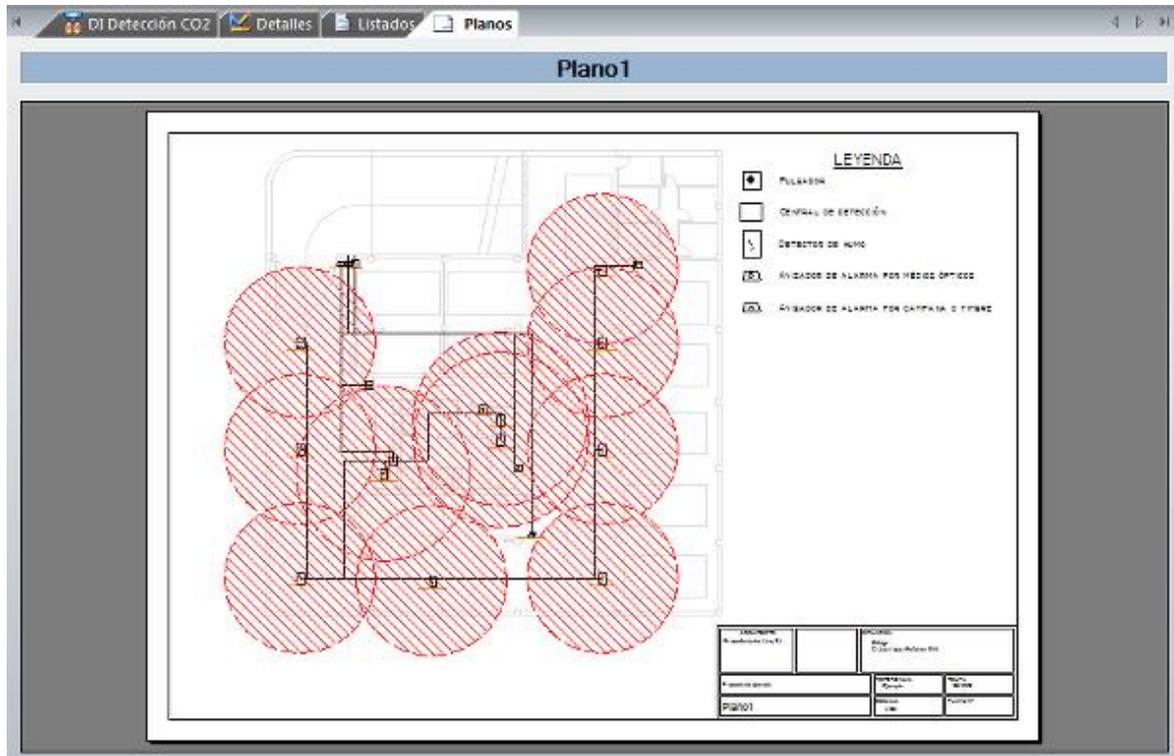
Plano de distribución. Fuente: <https://www.imventa.com/tk-di-deteccion-de-incendios>
